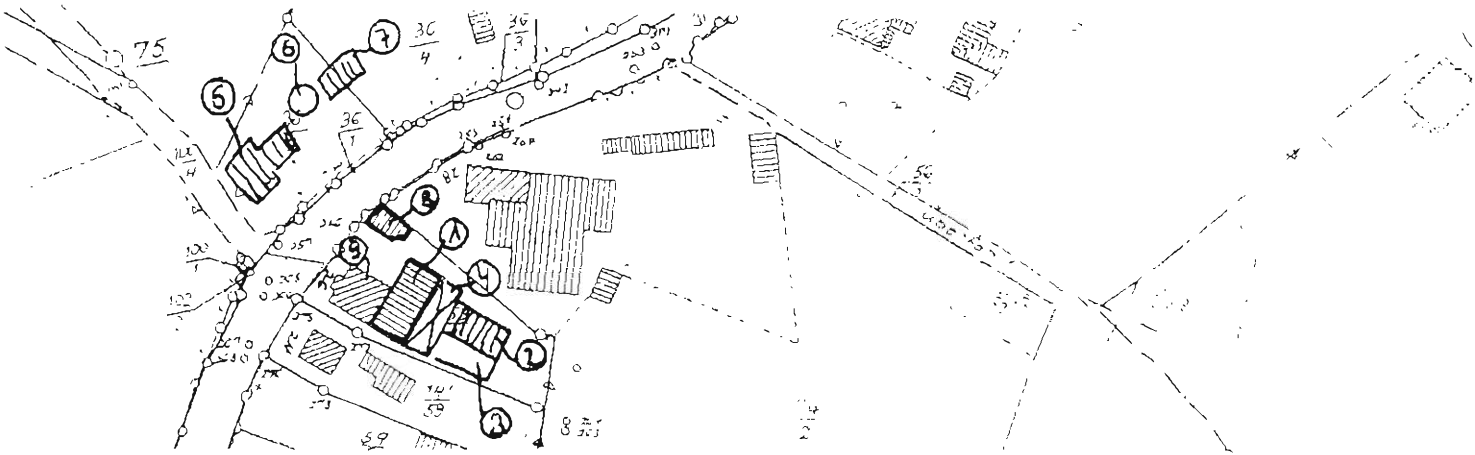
Lageplan (ca. M 1 : 4 000) über den betrachteten Bereich in Mehlbeck
